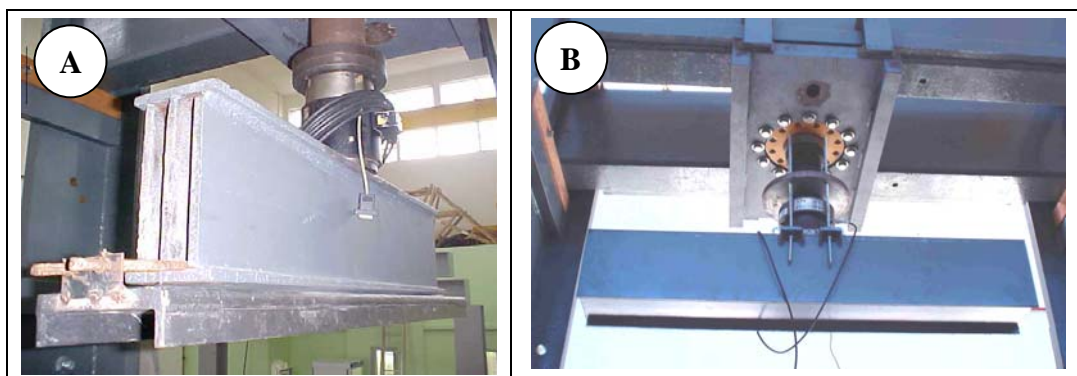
(A) Viga antiga e (B) Viga confeccionada para a execução dos experimentos
